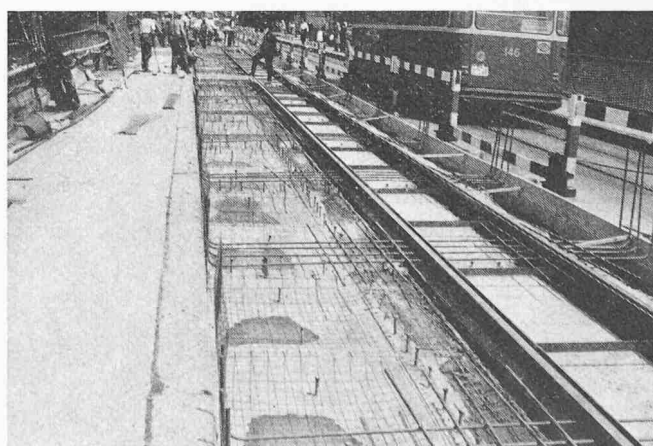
Fahrbahn kurz vor dem Betonieren. Man beachte die durch die Stege der Tramschienen durchgezogene obere Querarmierung über jedem Querträger (kleine Bogen)
